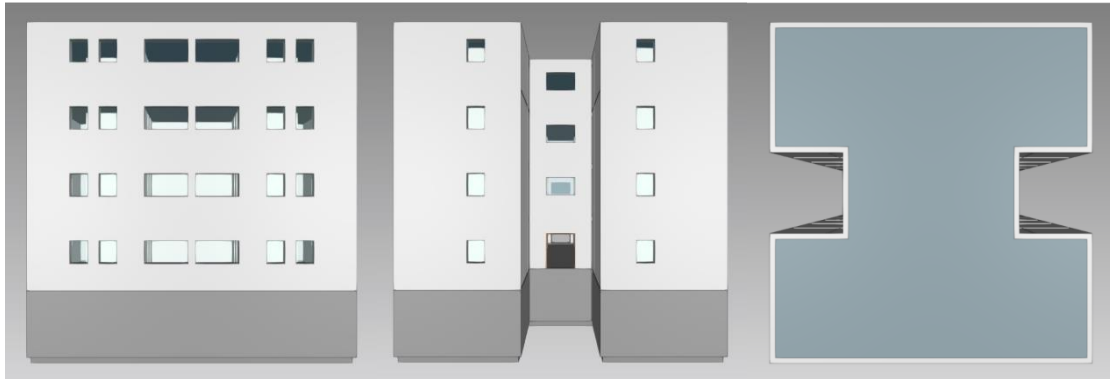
Perfil, alzado y planta del edificio en IFC BUILDER
